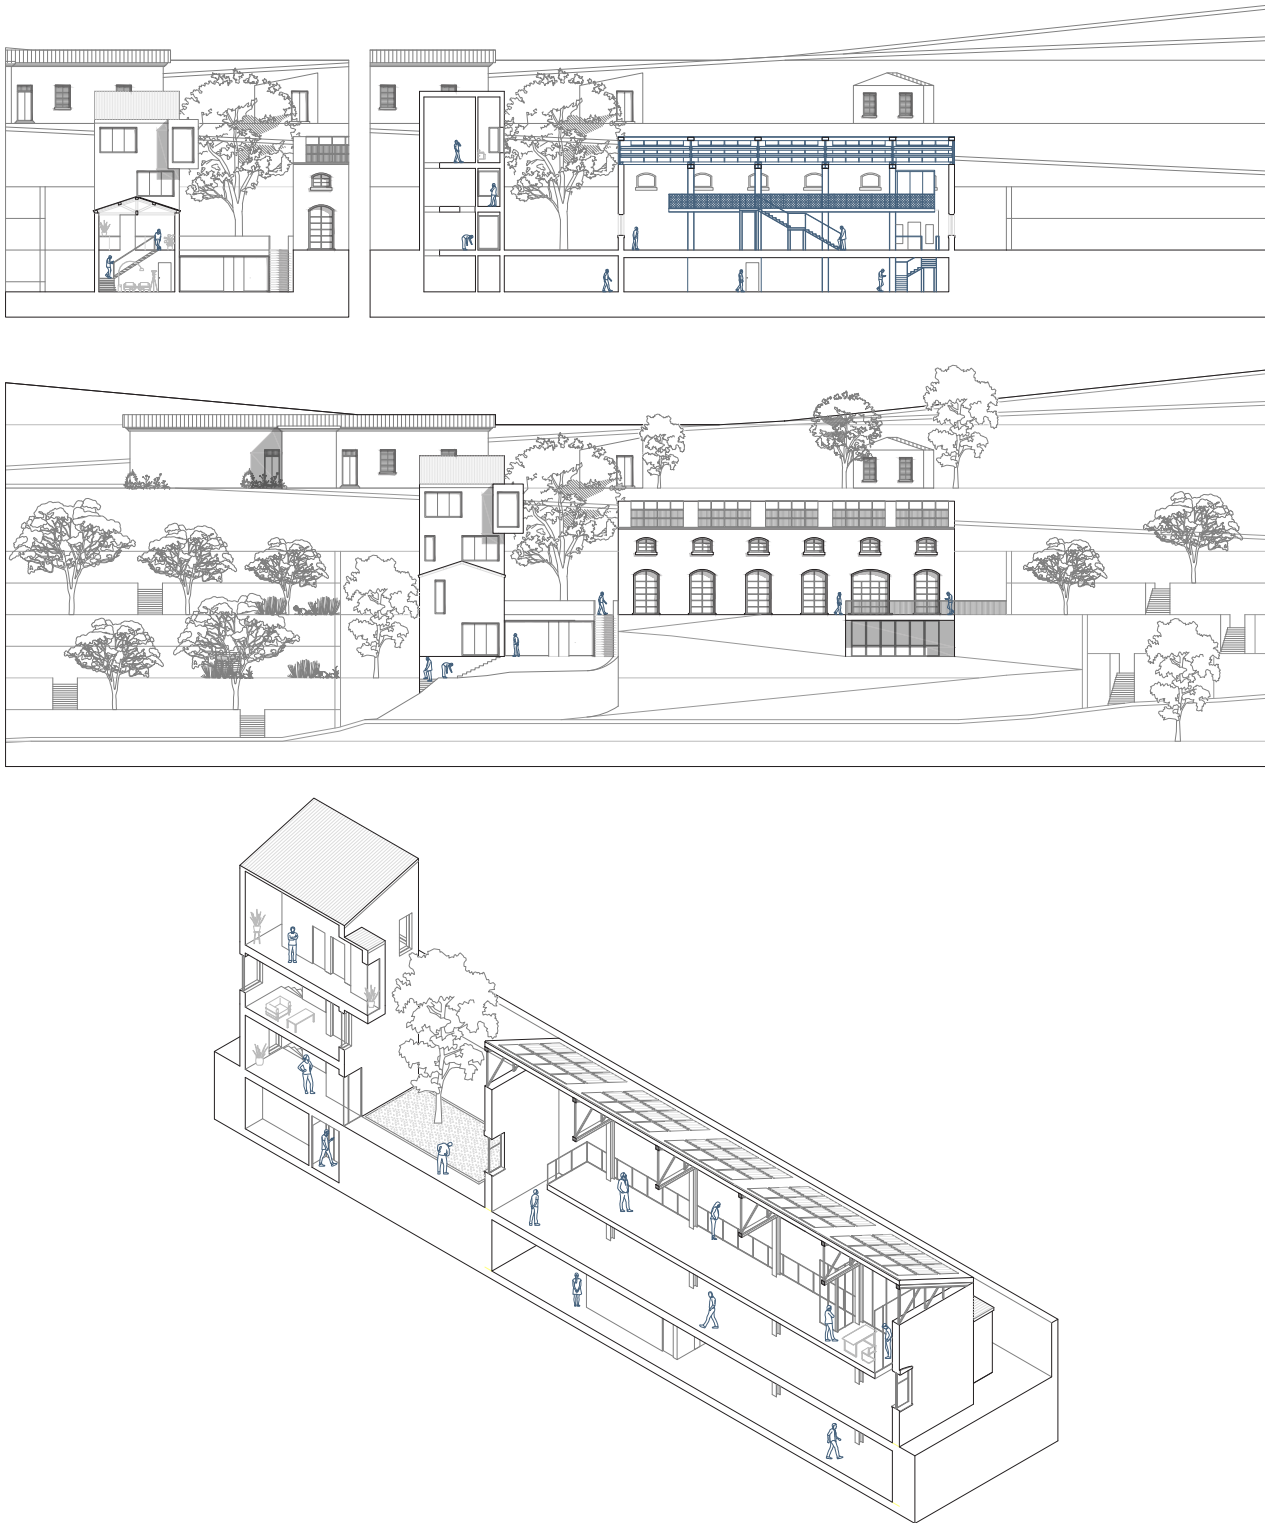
Prospetto principale, sezioni, e spaccato assometrico
